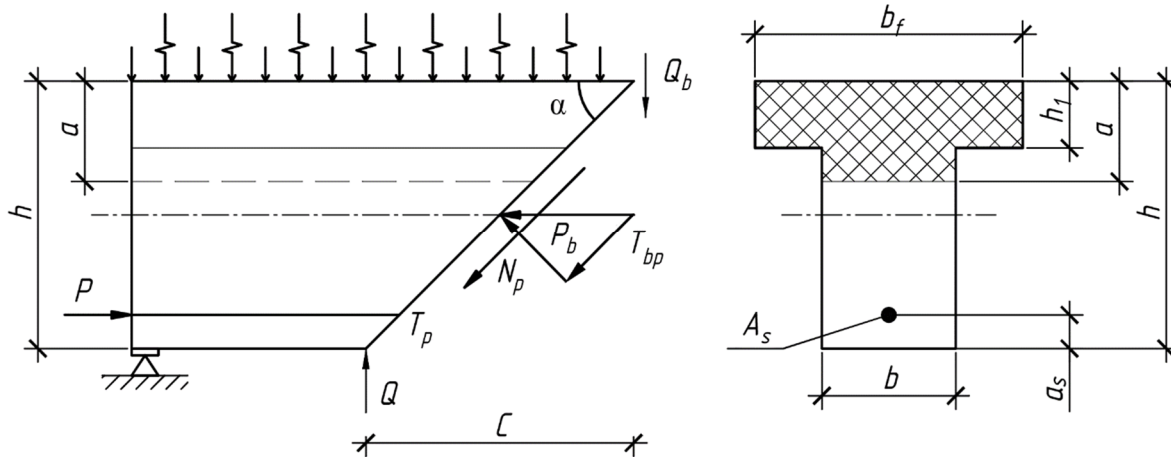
Схема усилий в сечении, наклонном к продольной оси железобетонного элемента с тавровой формой поперечного сечения
